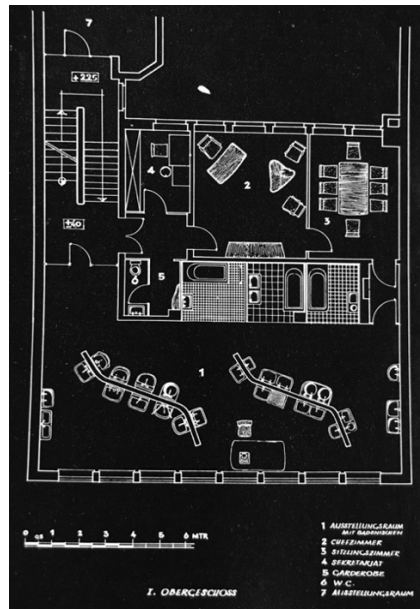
P. F. Schneider, Geschäftshaus Wolfferts, Grundriss Obergeschoss mit Präsentationswänden (aus: *Bauen und Wohnen*, 1951, Heft 10, S. 595)
